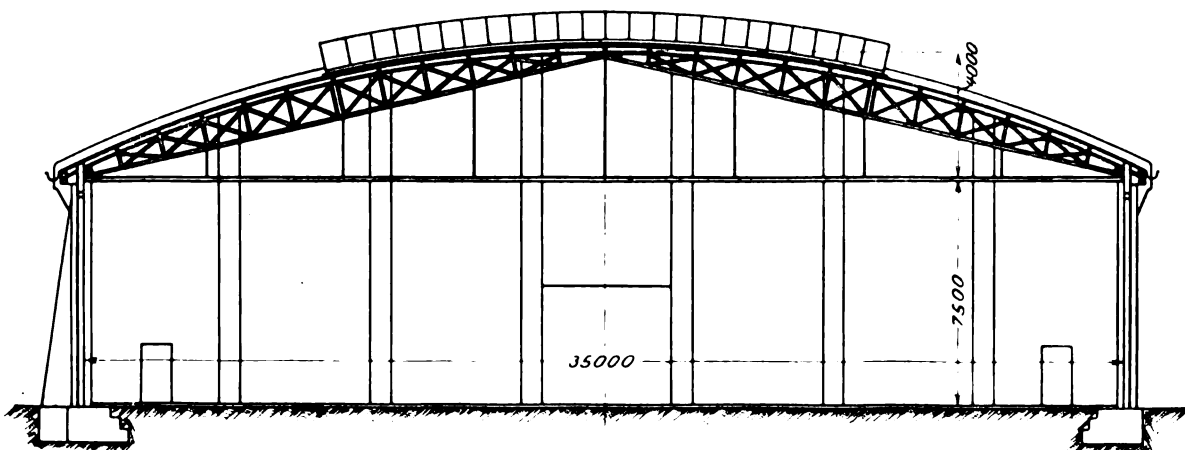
Querschnitt durch die hölzernen Dreigelenkbinder einer Flugzeughalle.
